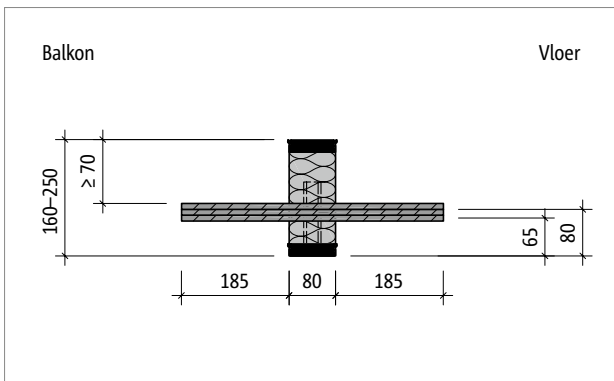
Schöck Isokorf® T type H-NN1: Bovenaanzicht
